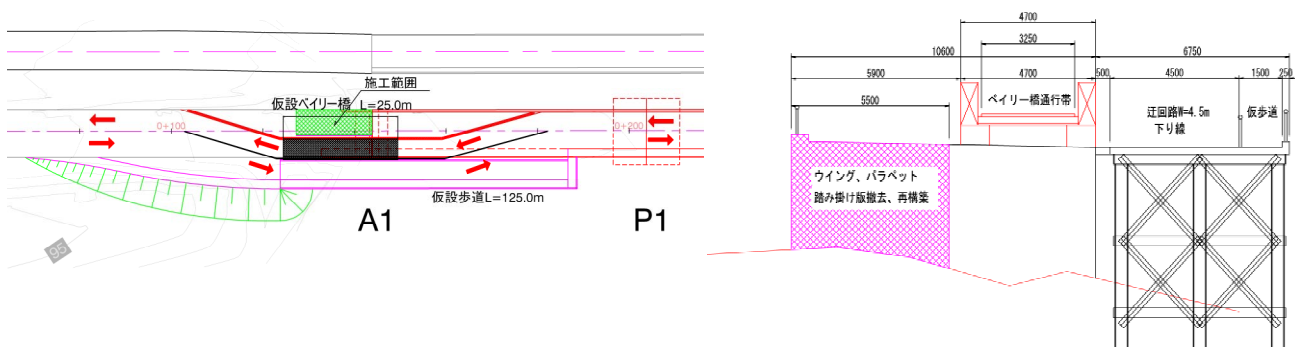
橋台パラペットの復旧工事切り回し計画平面図
